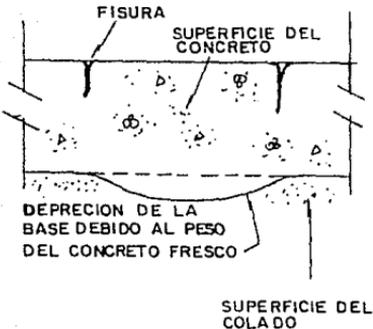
FISURA DEBIDO AL ASIENTO DE LA SUPERFICIE DE COLADO DURANTE LA CONSTRUCCION.
